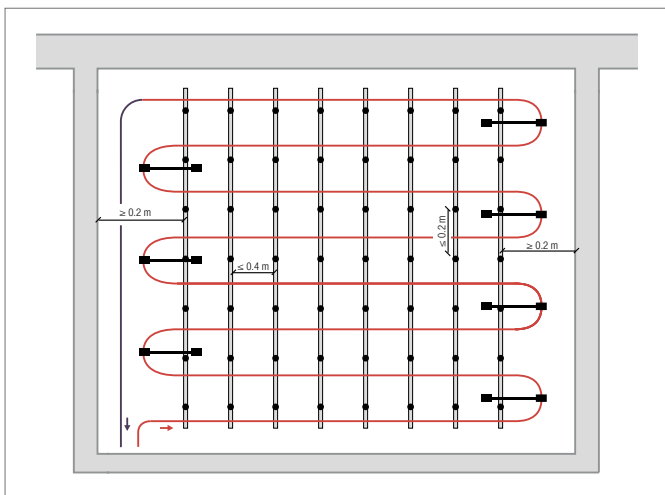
Disposición con ranura simple, paso 10 (vista desde arriba sobre el pavimento)
